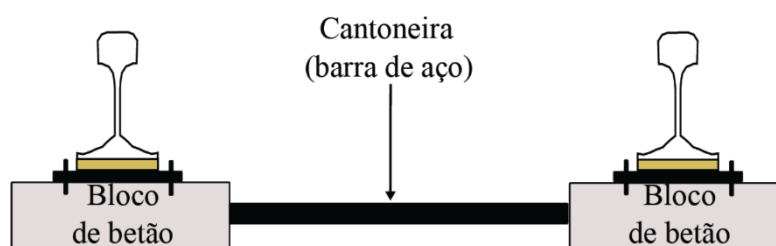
Travessa de betão bi-bloco, exemplo esquemático (Vale, 2010)
